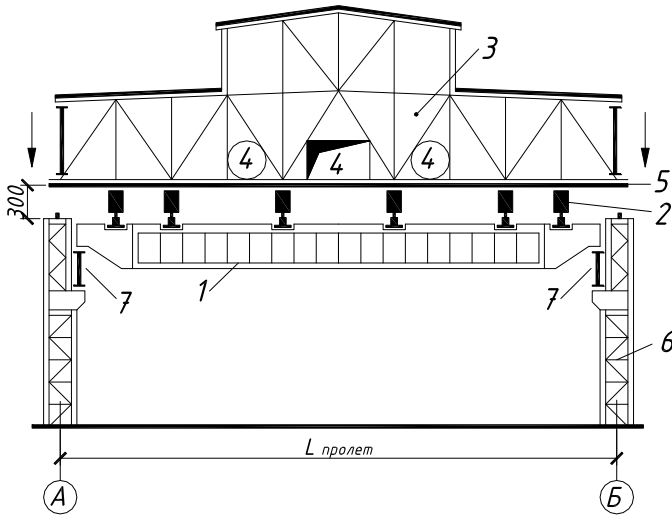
Схема монтажа блоков покрытия промышленного здания с использованием низкого установщика:
